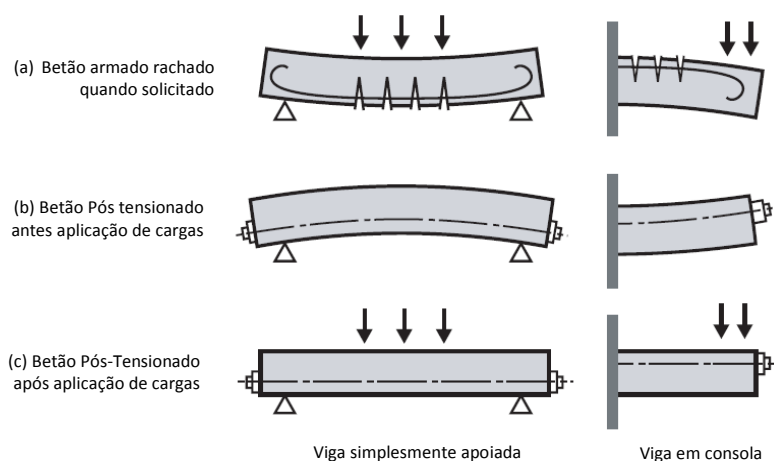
Comparação de vigas de betão armado normal e com pré-esforço [adaptado de [55]]
